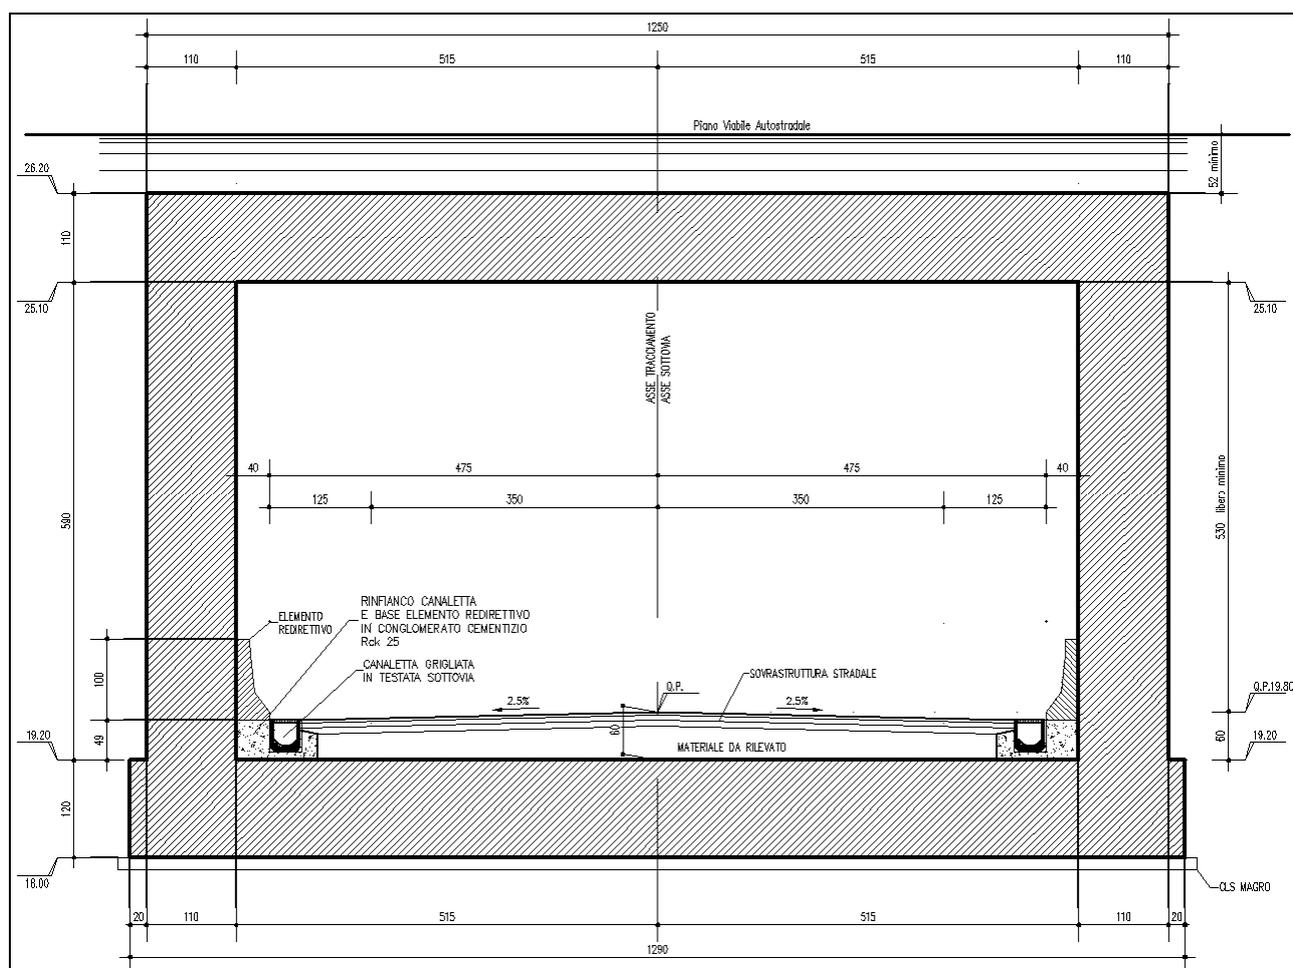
SEZIONE TRASVERSALE DEL SOTTOVIA
